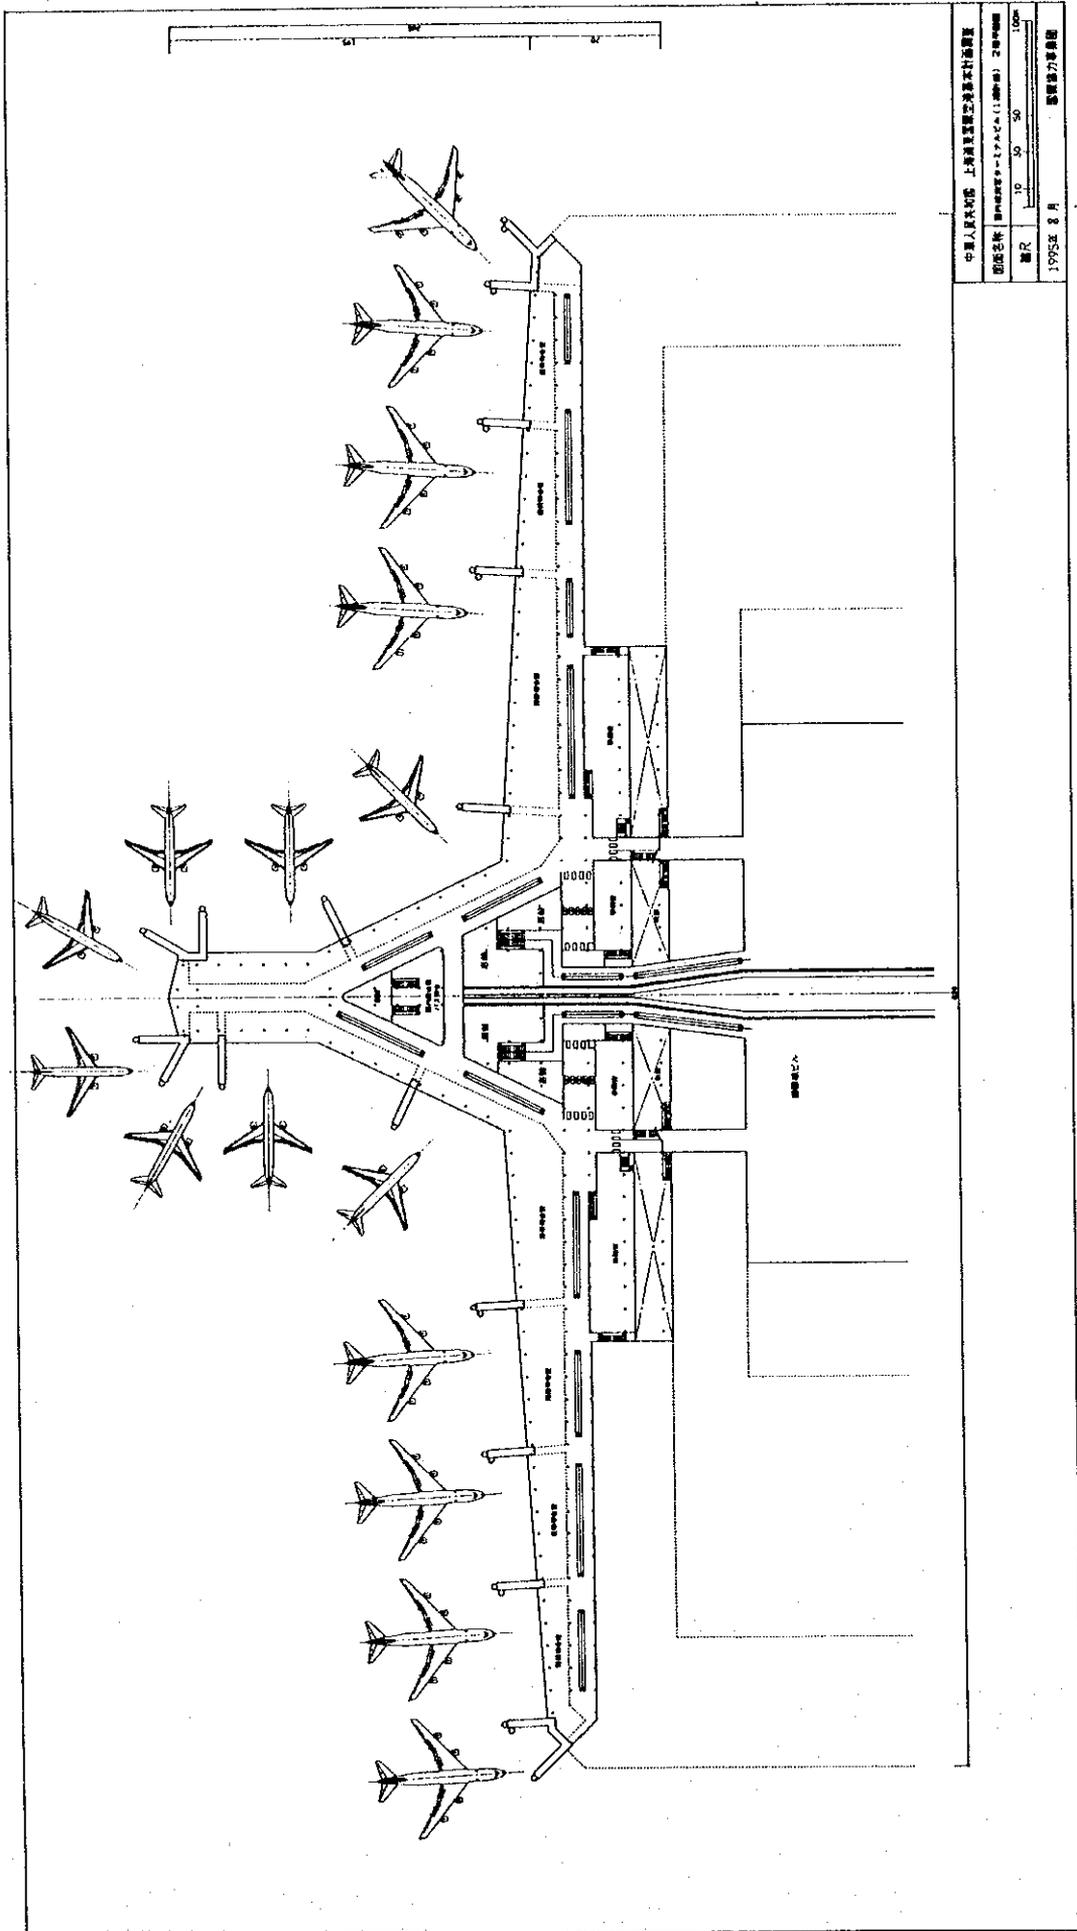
国内線旅客ターミナルビル(1期計画) 2階平面図
